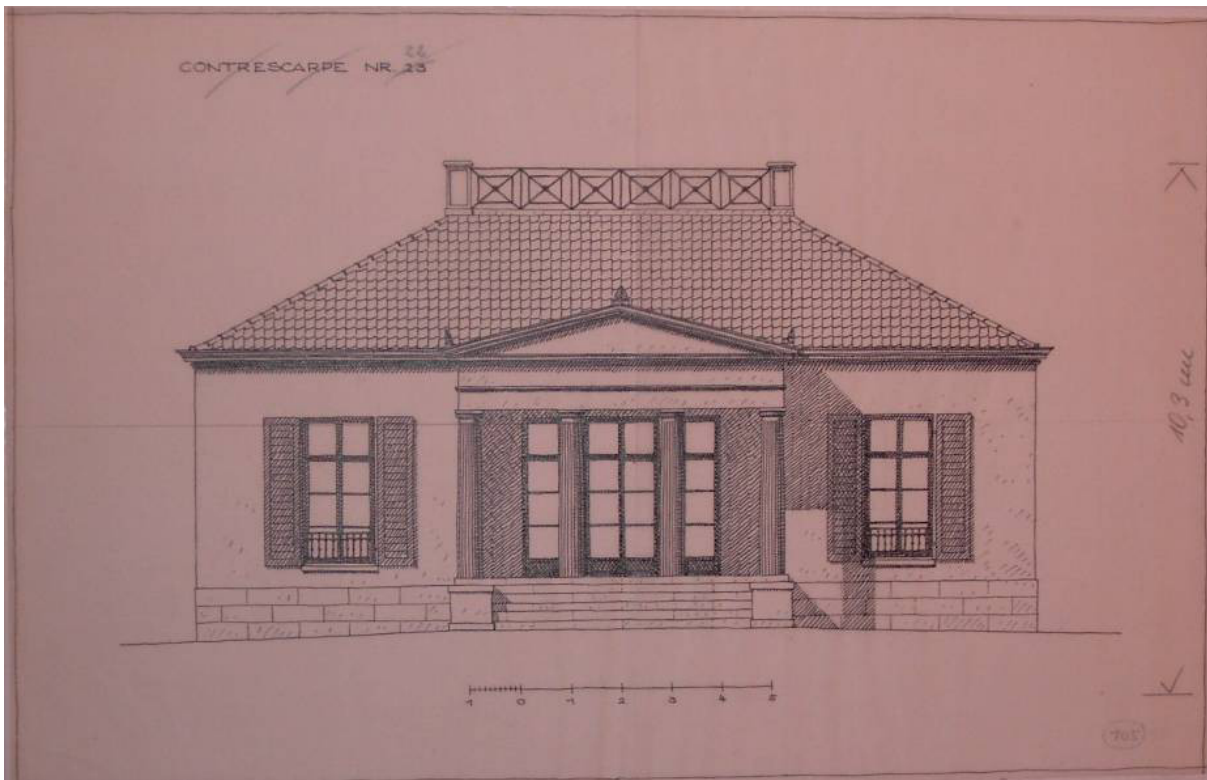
Jacob Ephraim Polzin, 1822: Contrescarpe 22, LfD Bremen, Planarchiv
